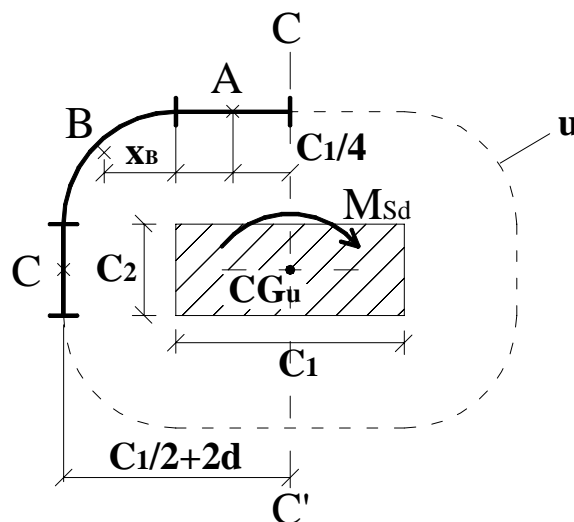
Trechos para cálculo de W_1 para lajes sem furo, L14
